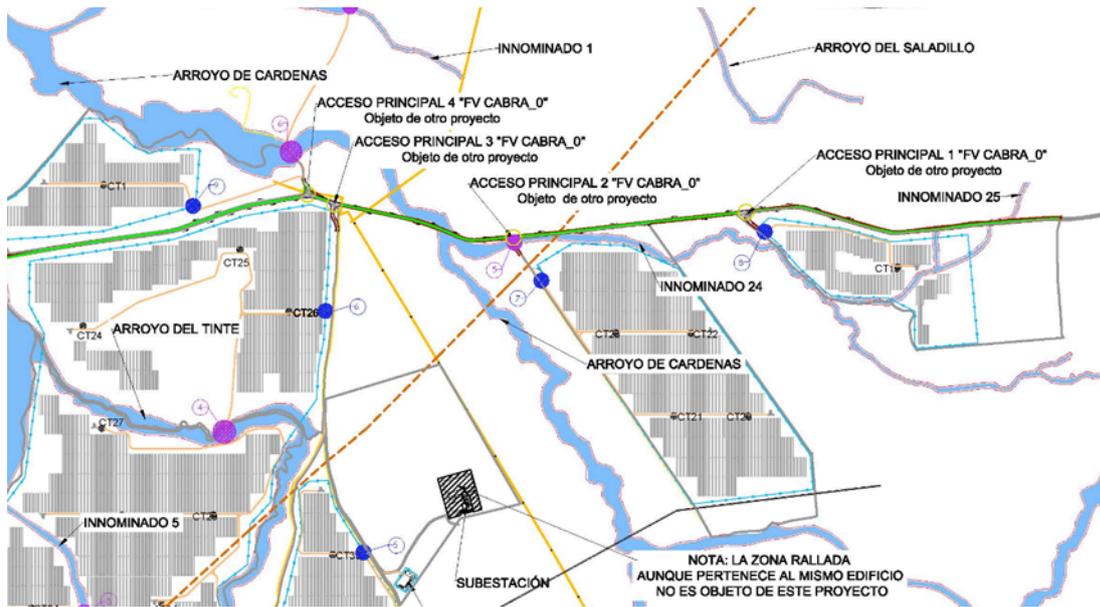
Accesos a la Planta Solar Fotovoltaica.
